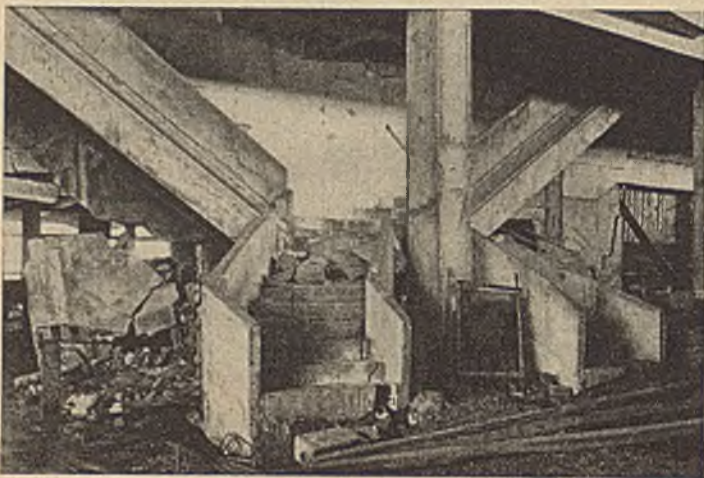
Gebäude der Buick-Agentur: Die zu Bruch gegangene Sandsteintreppe der Ausstellungshalle (noch im Rohbauzustand). — Die beiden frontal ansteigenden gebrochenen Läufe (in piedra cantera) wurden von der Eisenbetonkonstruktion der zur Galerie führenden Treppe abgesprengt. — In der Mitte Rahmenstütze 40/50 cm. Links auf dem Bilde eine gegen die Türöffnung hin abgesprengte Zementsteinwand; rechts ebenfalls Rißbildungen in der Ausfüllwand.
